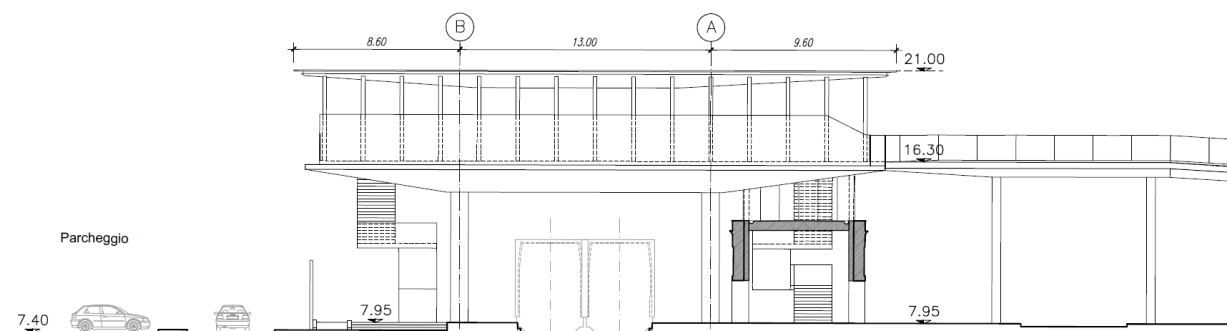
Sezione longitudinale esterna alla piastra di collegamento
